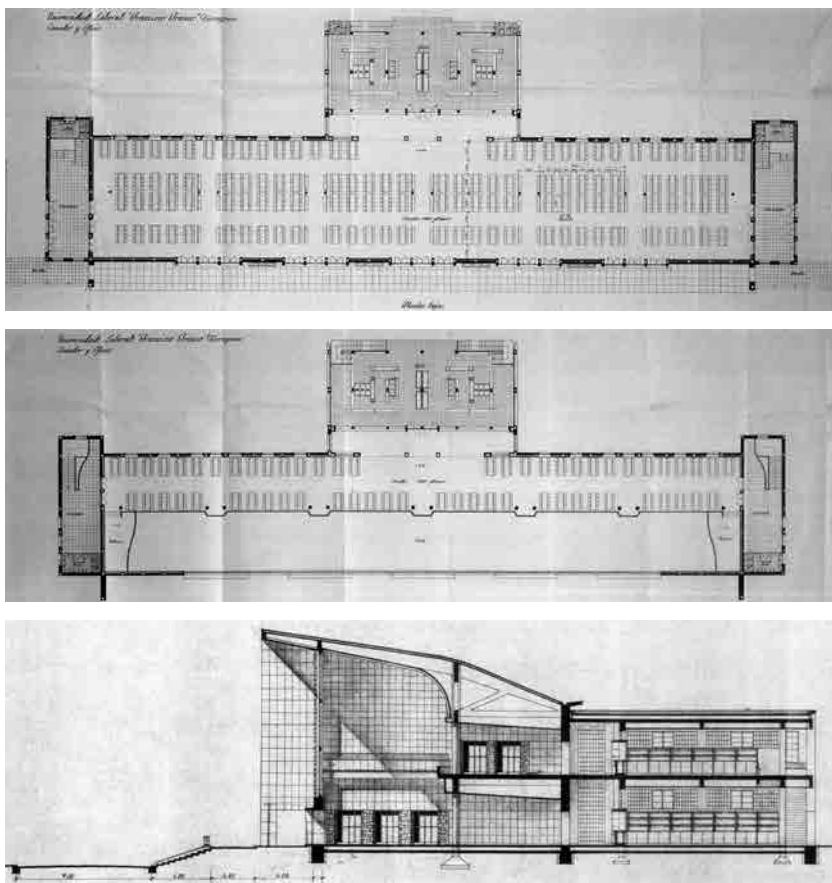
, Fig. 28 y Fig. 29 Comedor. Planta baja (arriba), planta alta (centro) y sección transversal (abajo).
